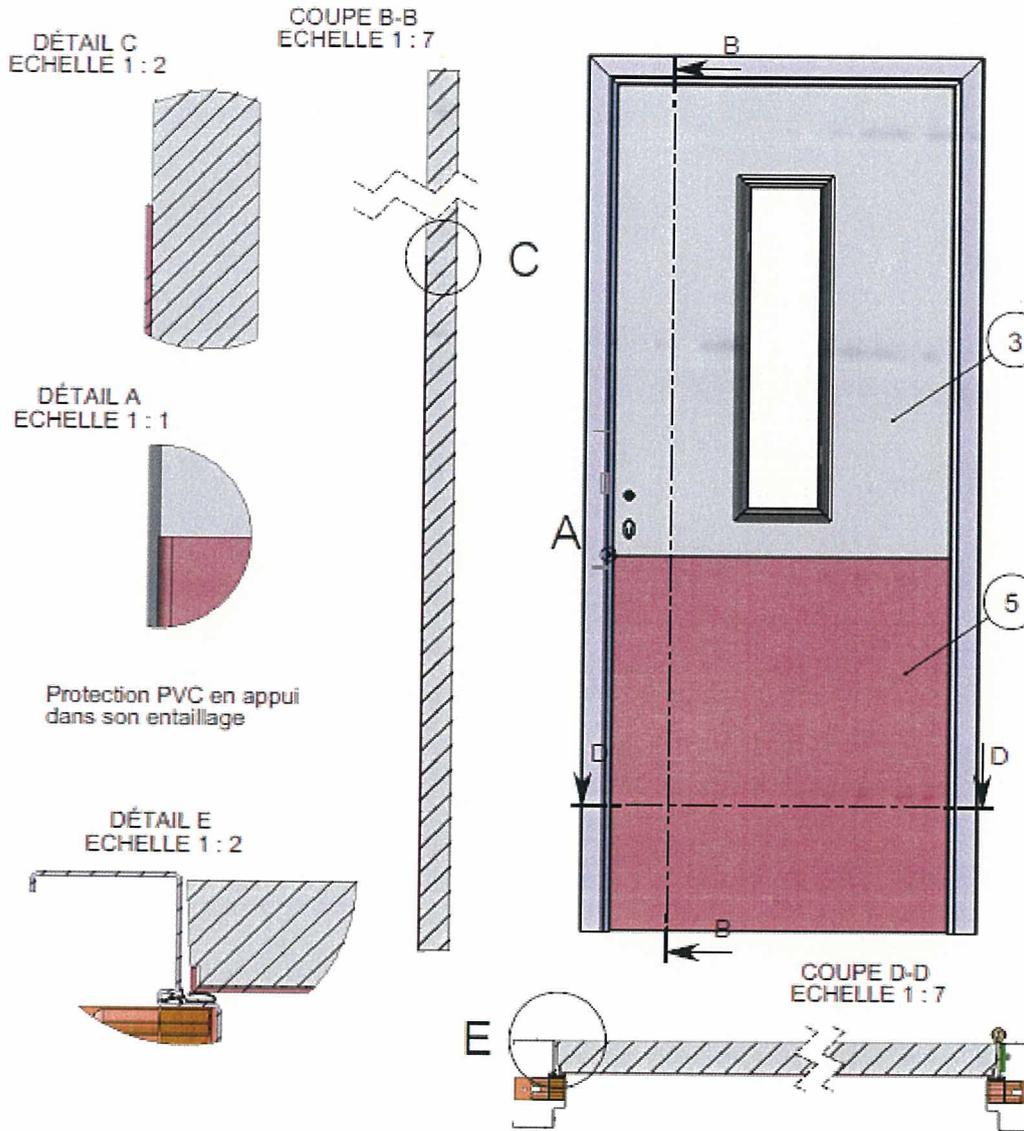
plan n° E54-07 005 d'implantation de l'habillage PVC
